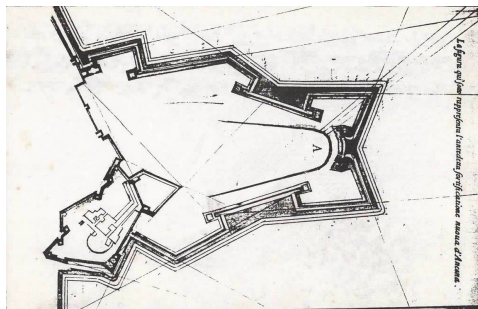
Planimetria storica della Cittadella-Fortezza (Anonimo, secolo non noto).
